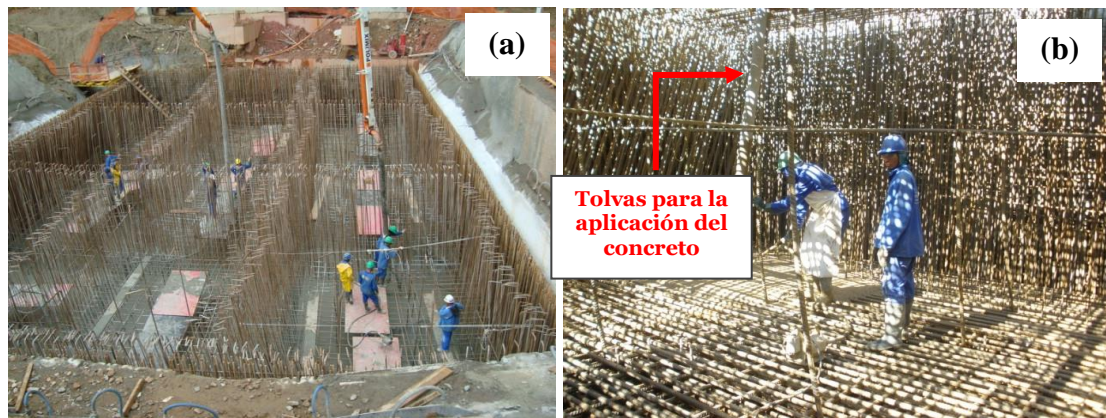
(a) Hormigonado de la segunda capa sin la armadura superior y (b) hormigonado después de haber colocado toda la armadura.
